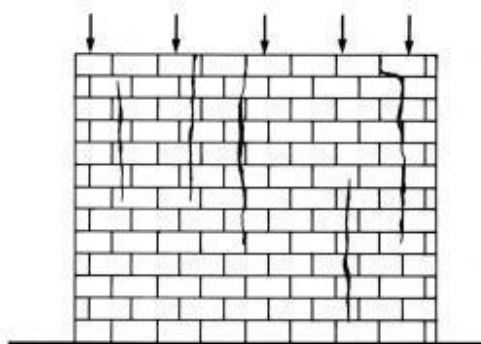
Fissuras verticais causadas por sobrecarga vertical distribuída.
